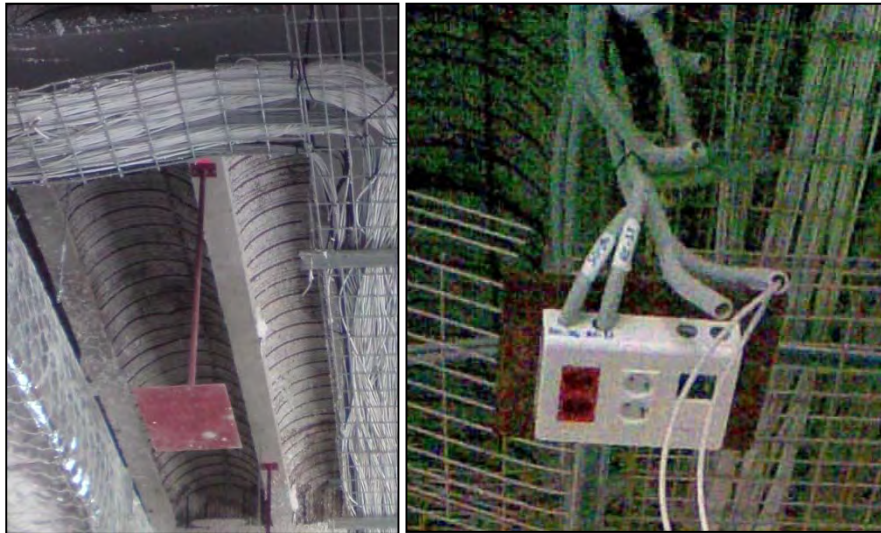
Detalle Instalación Pletina Metálica para instalación de Cajas Mixtas tipo CIMA para la RMS.
